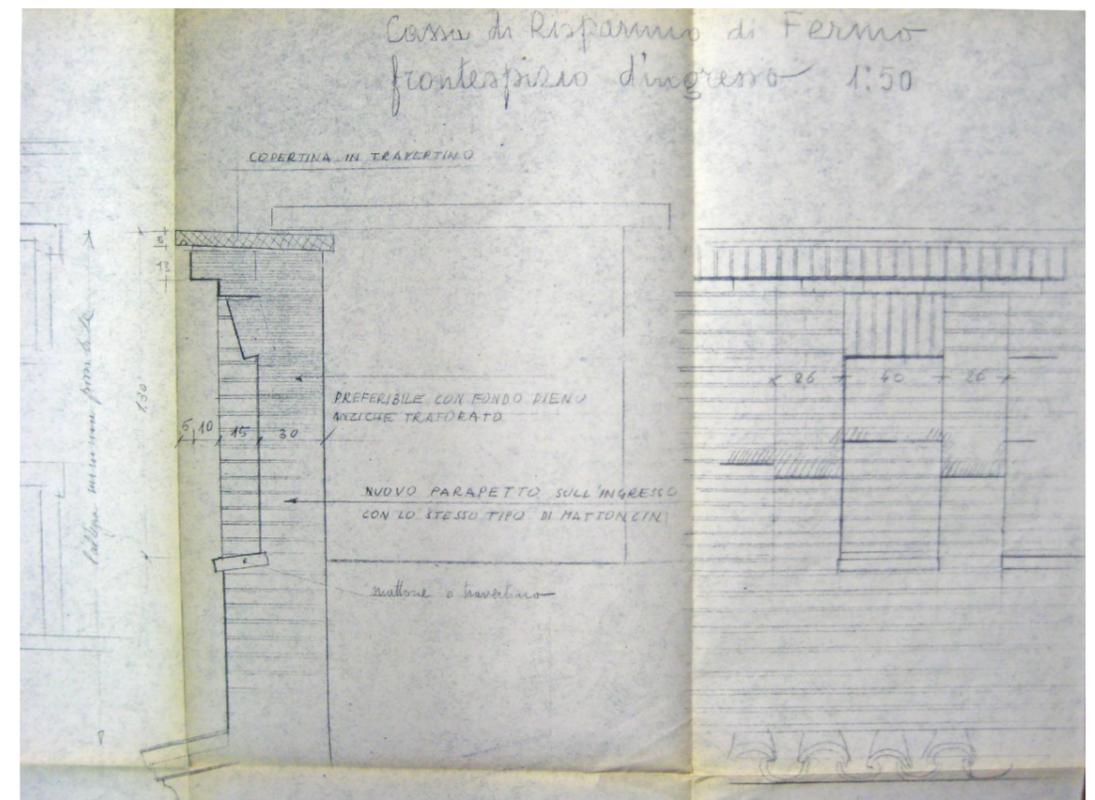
Particolare del frontespizio d'ingresso. Progetto dell'architetto Tassotti. Archivio di Stato di Fermo.
